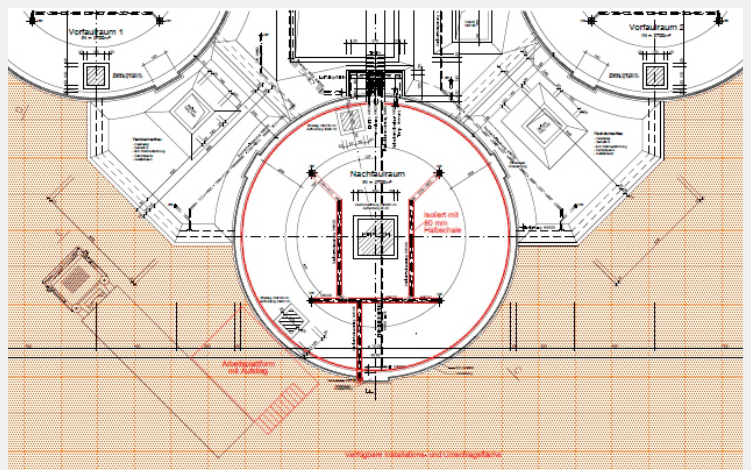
Grundrissplan des Nachfaulraums / Plan du digesteur secondaire
